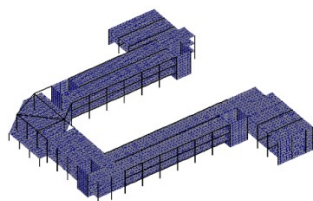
Расчетная схема здания с сеткой конечных элементов
